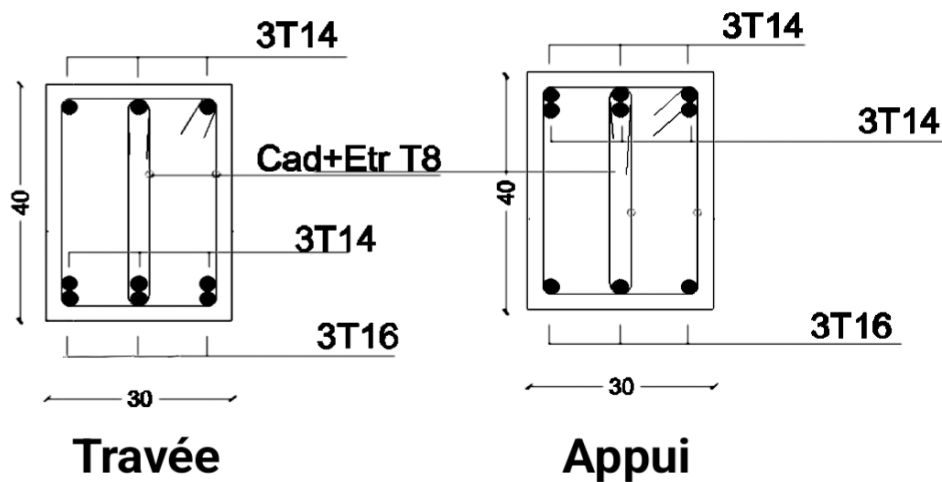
Ferraillage des poutres principales de l'Etage courant, RDC.
